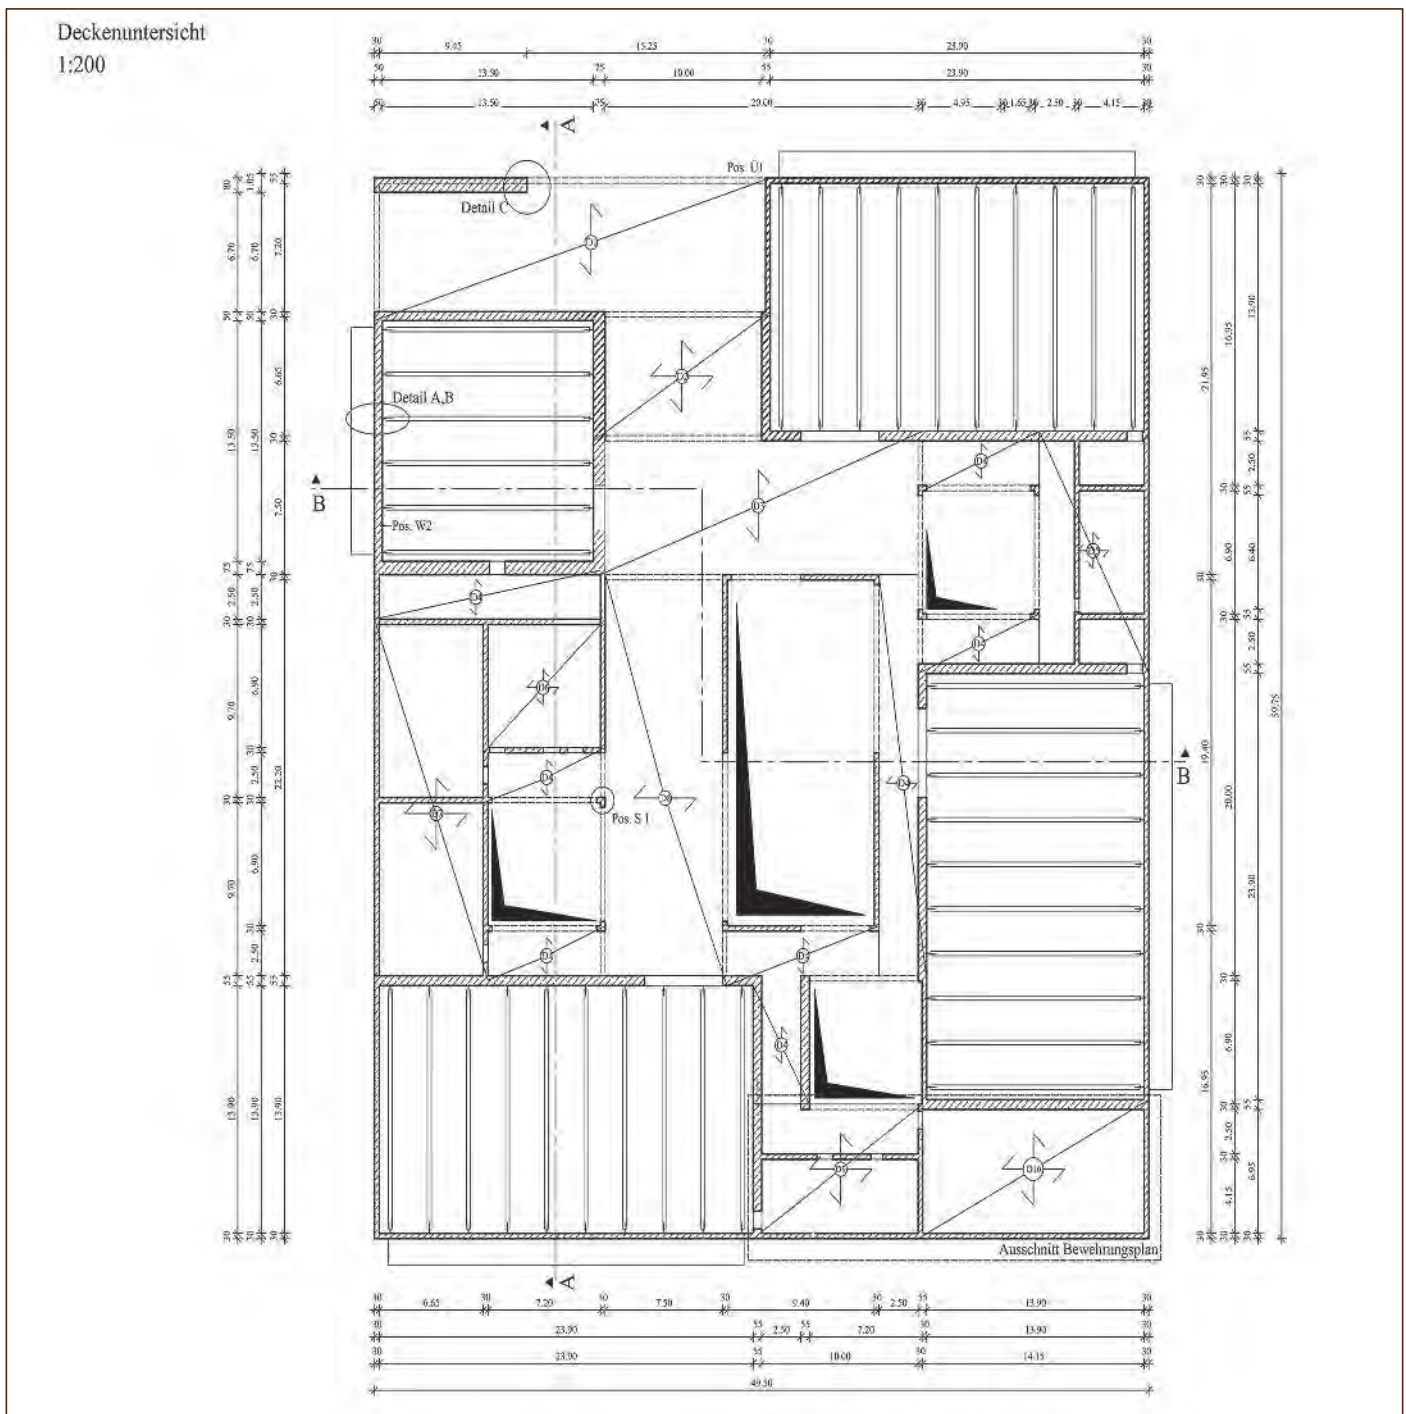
Deckenuntersicht, Projekt 2 – Sporthalle WS 2014/15, Verfasser: Arne Wittenborn (Bachelor Architektur) und Michael Adeling (Bachelor Bauingenieurwesen), betreut an den Lehrstühlen Baukonstruktion und Stahlbau
